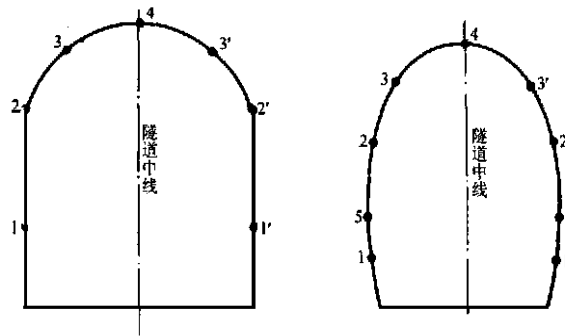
直墙断面测点布置图 图 8 曲墙断面测点布置图
